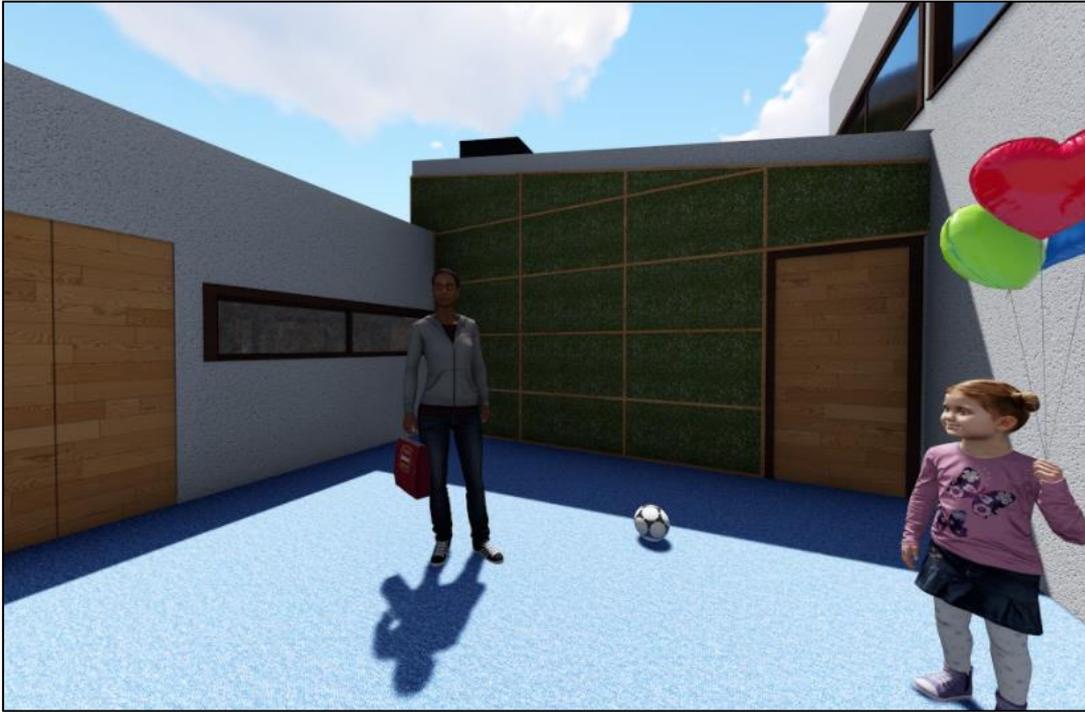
Vista frontal del muro verde en baño interior de las aulas
